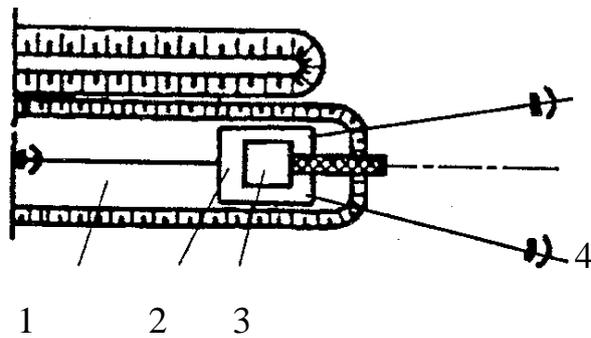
Схема разработки грунта экскаватором на понтоне[9]:
